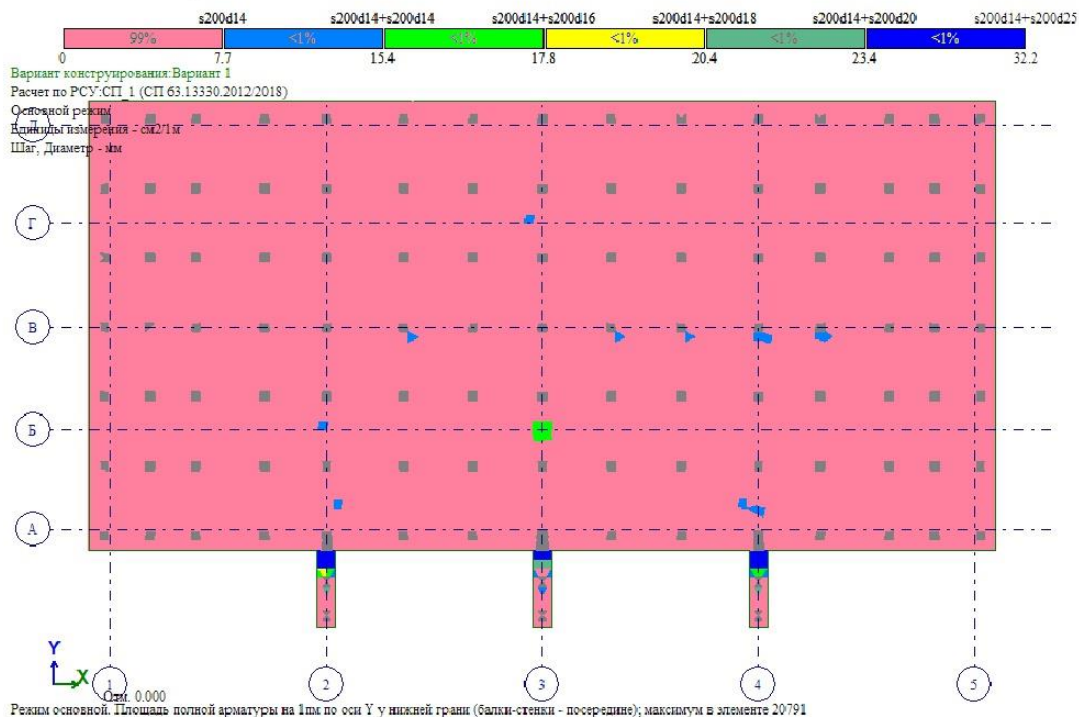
Требуемое нижнее армирование вдоль оси Y
